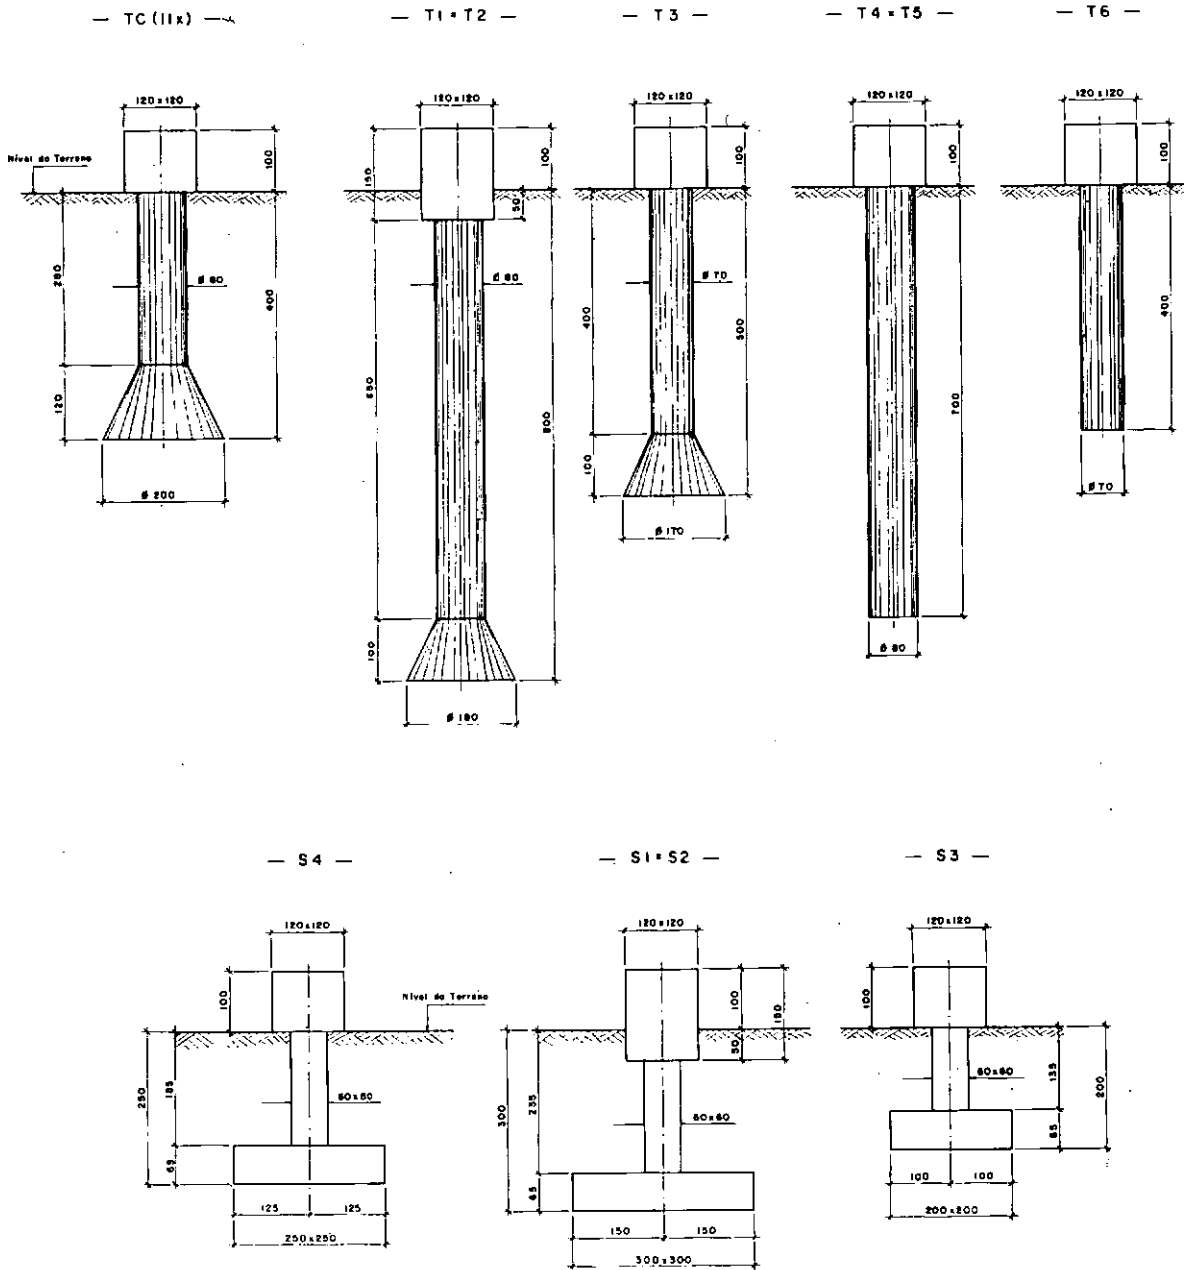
b - Arranjo geral das provas de carga (elevações).
